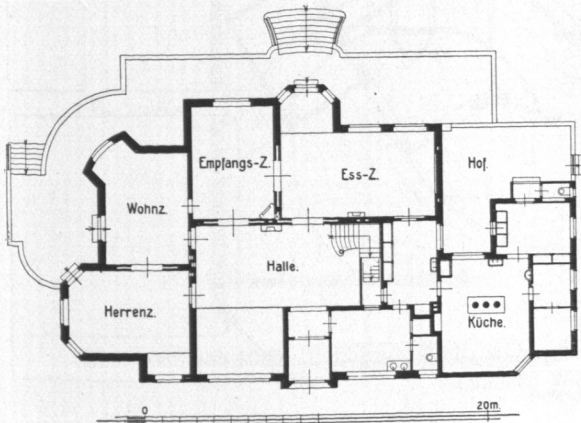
Haus Lejewitz, Numühle, Erdgesch. b., erbaut 1899 durch Architekt Ernst P. Dorn.
